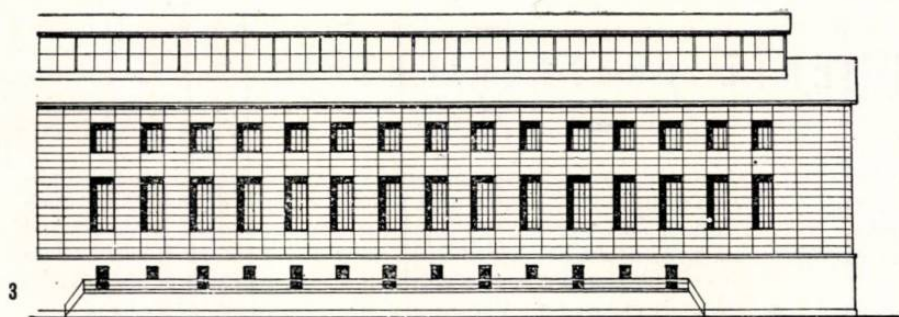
Hală de fabricație. Fațada laterală. Plăci și ferestre prefabricate din beton armat.
